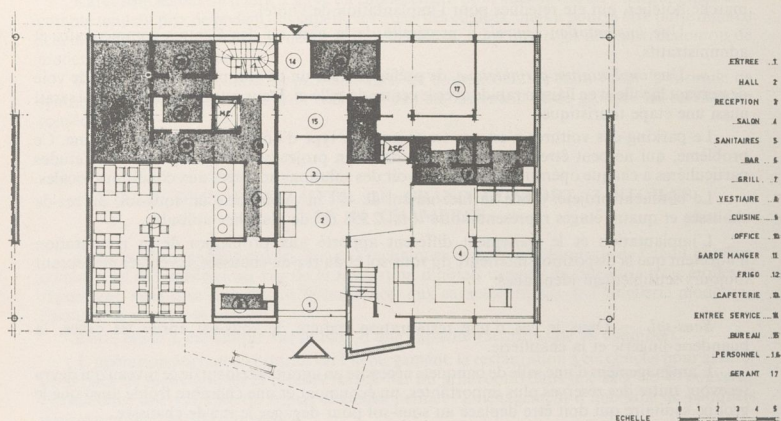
Rez-de-chaussée. Cas d'une restauration réduite.
